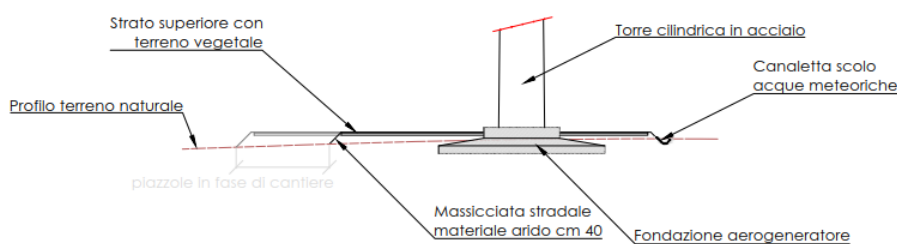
Planimetria tipologica ripristino aree piazzole
